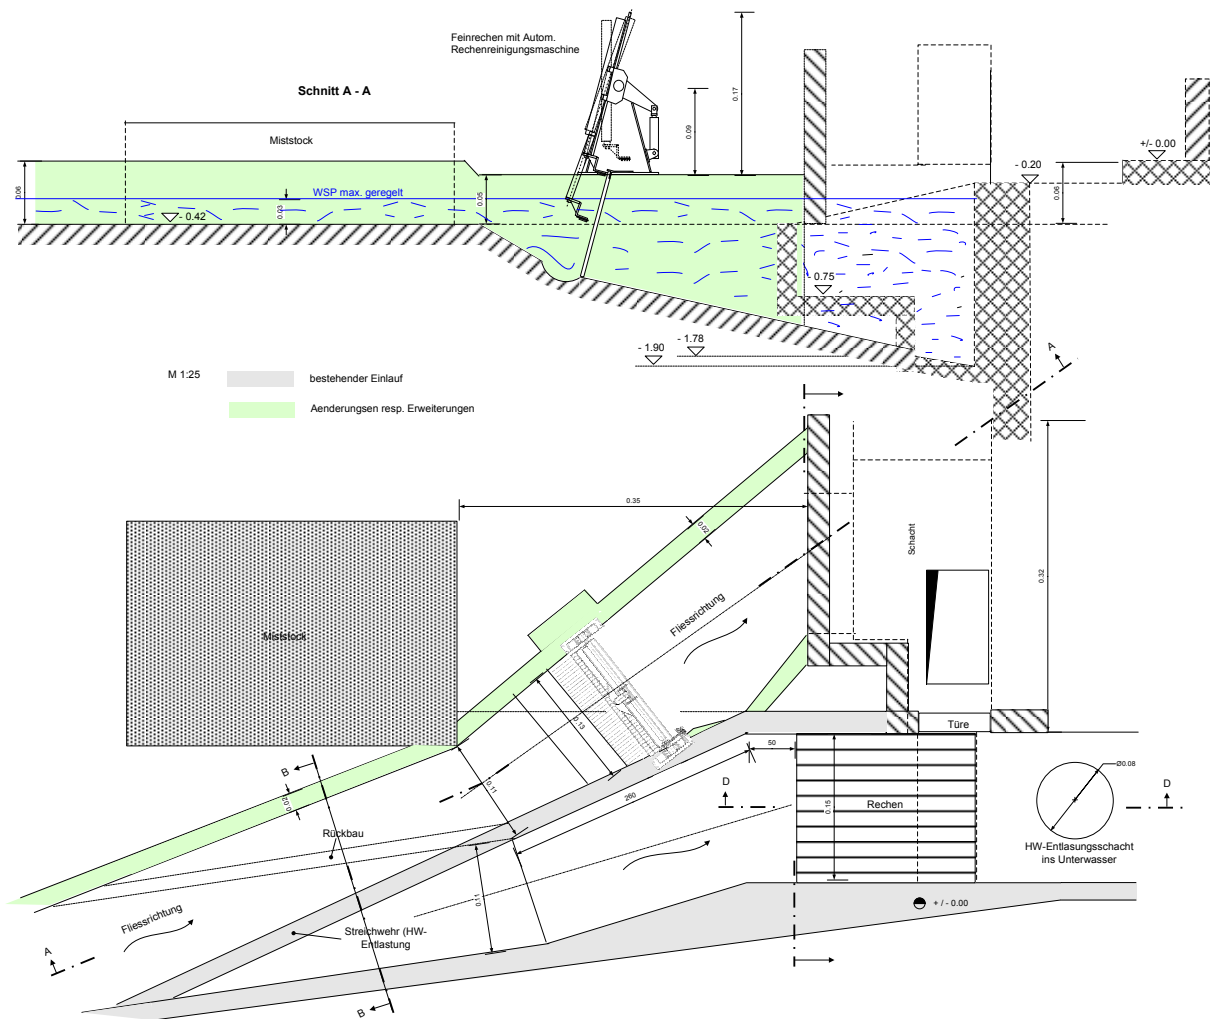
Grundriss und Querschnitt vom Einlauf mit Feinrechen
